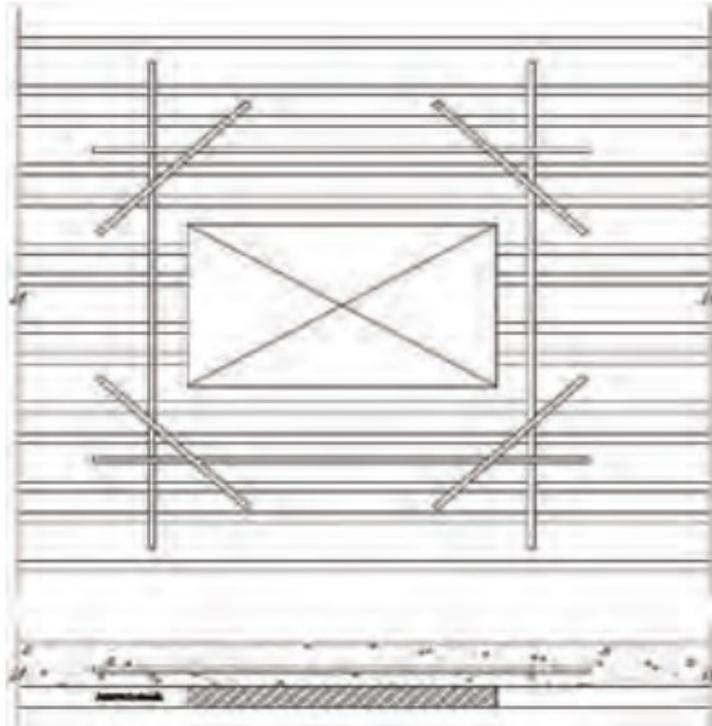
Diseño de refuerzo en ductos. Fuente: Aceros Procesados S.A. (2021)
